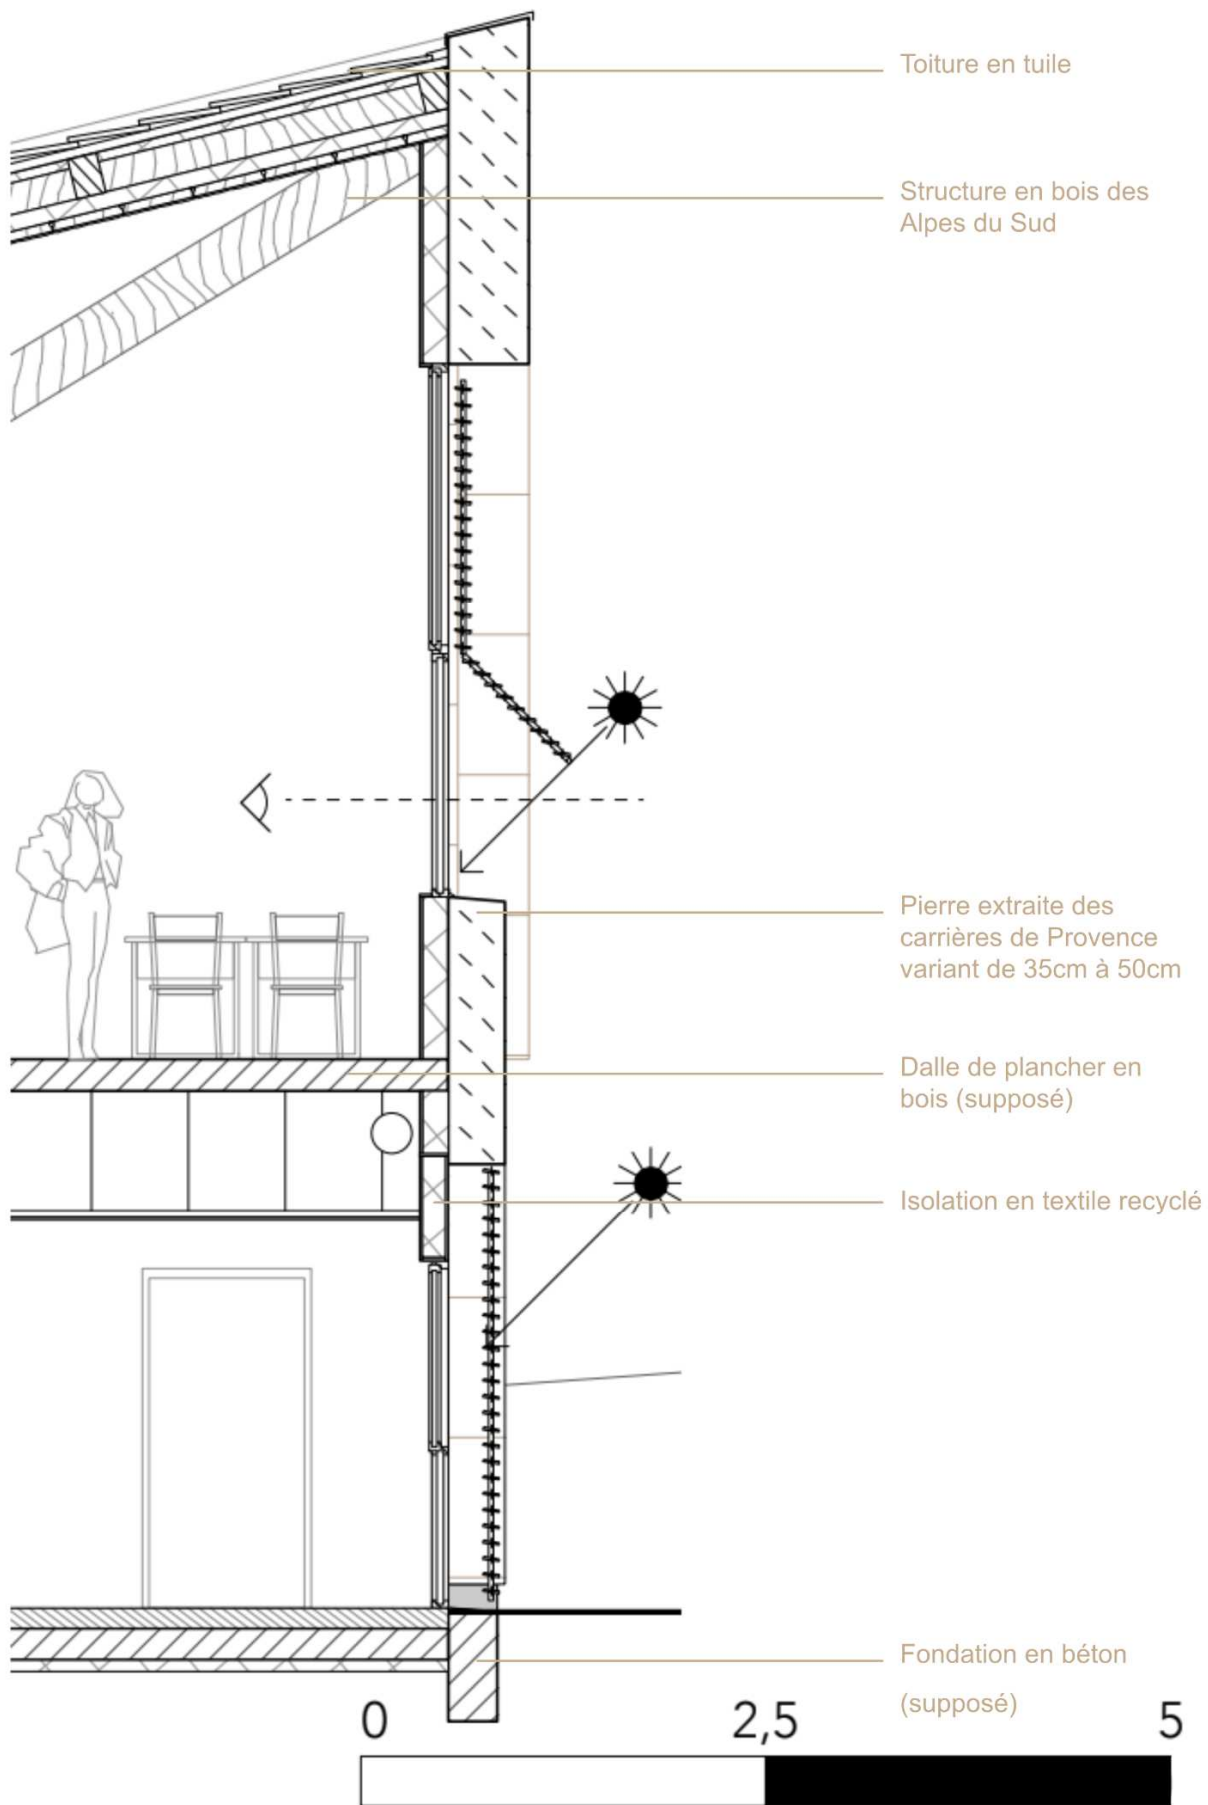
Coupe longitudinale du projet du Groupe scolaire à Opio.
